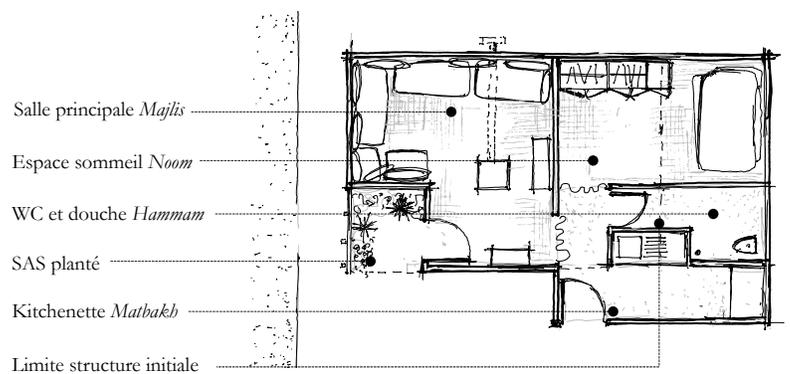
Plan et coupe avec les interventions communes à la plupart des structures (Kikano, 2020)
